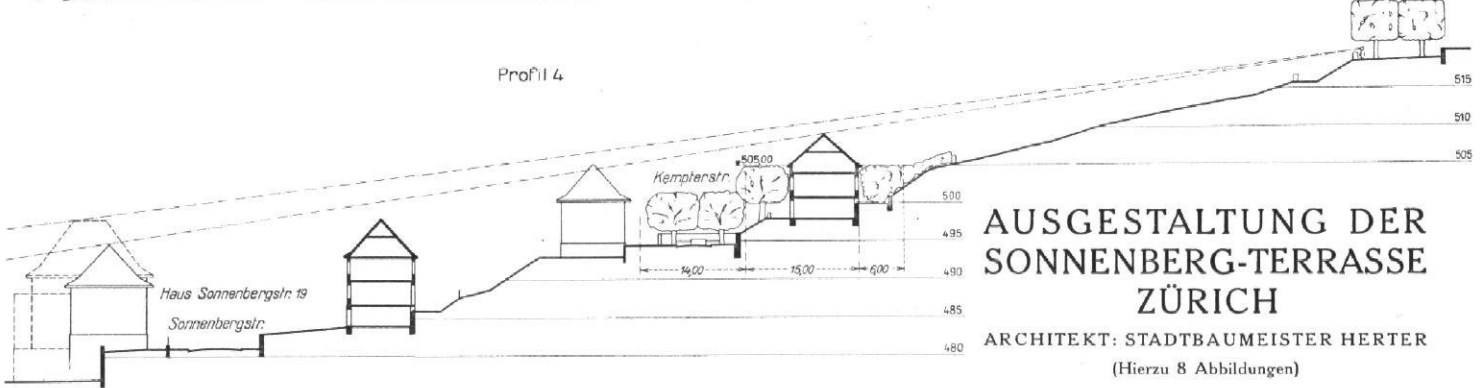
und 3 / Profile 4 und 9 zum Lageplan (Abb. 1)
